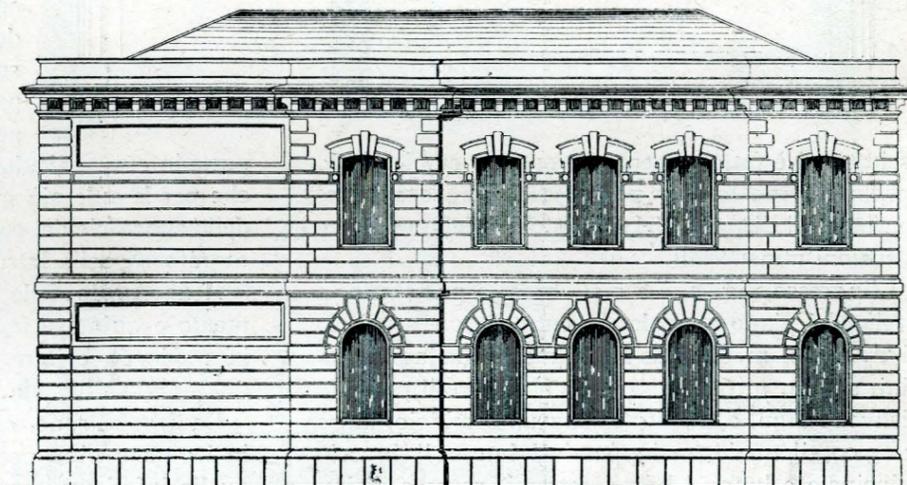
Prospetto geometrico laterale a tramontana - Scala 1:200
